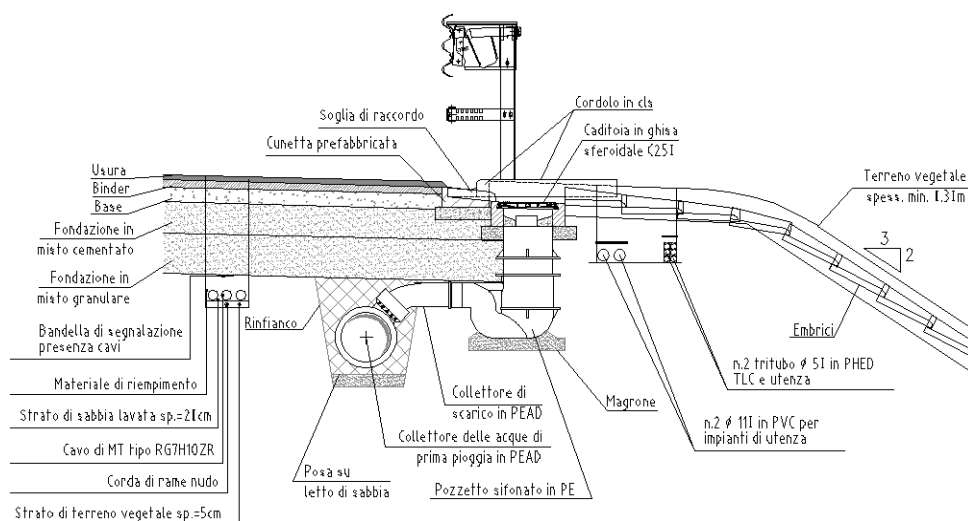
Sistema di drenaggio in rilevato in corrispondenza del pozzetto
